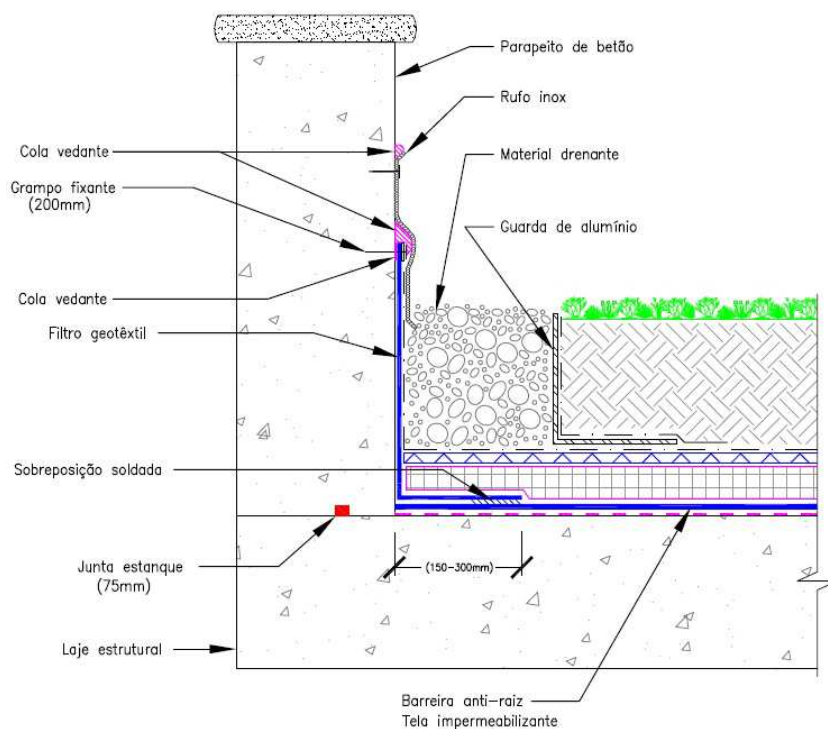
Pormenor de um acabamento em parapeito, [30].
